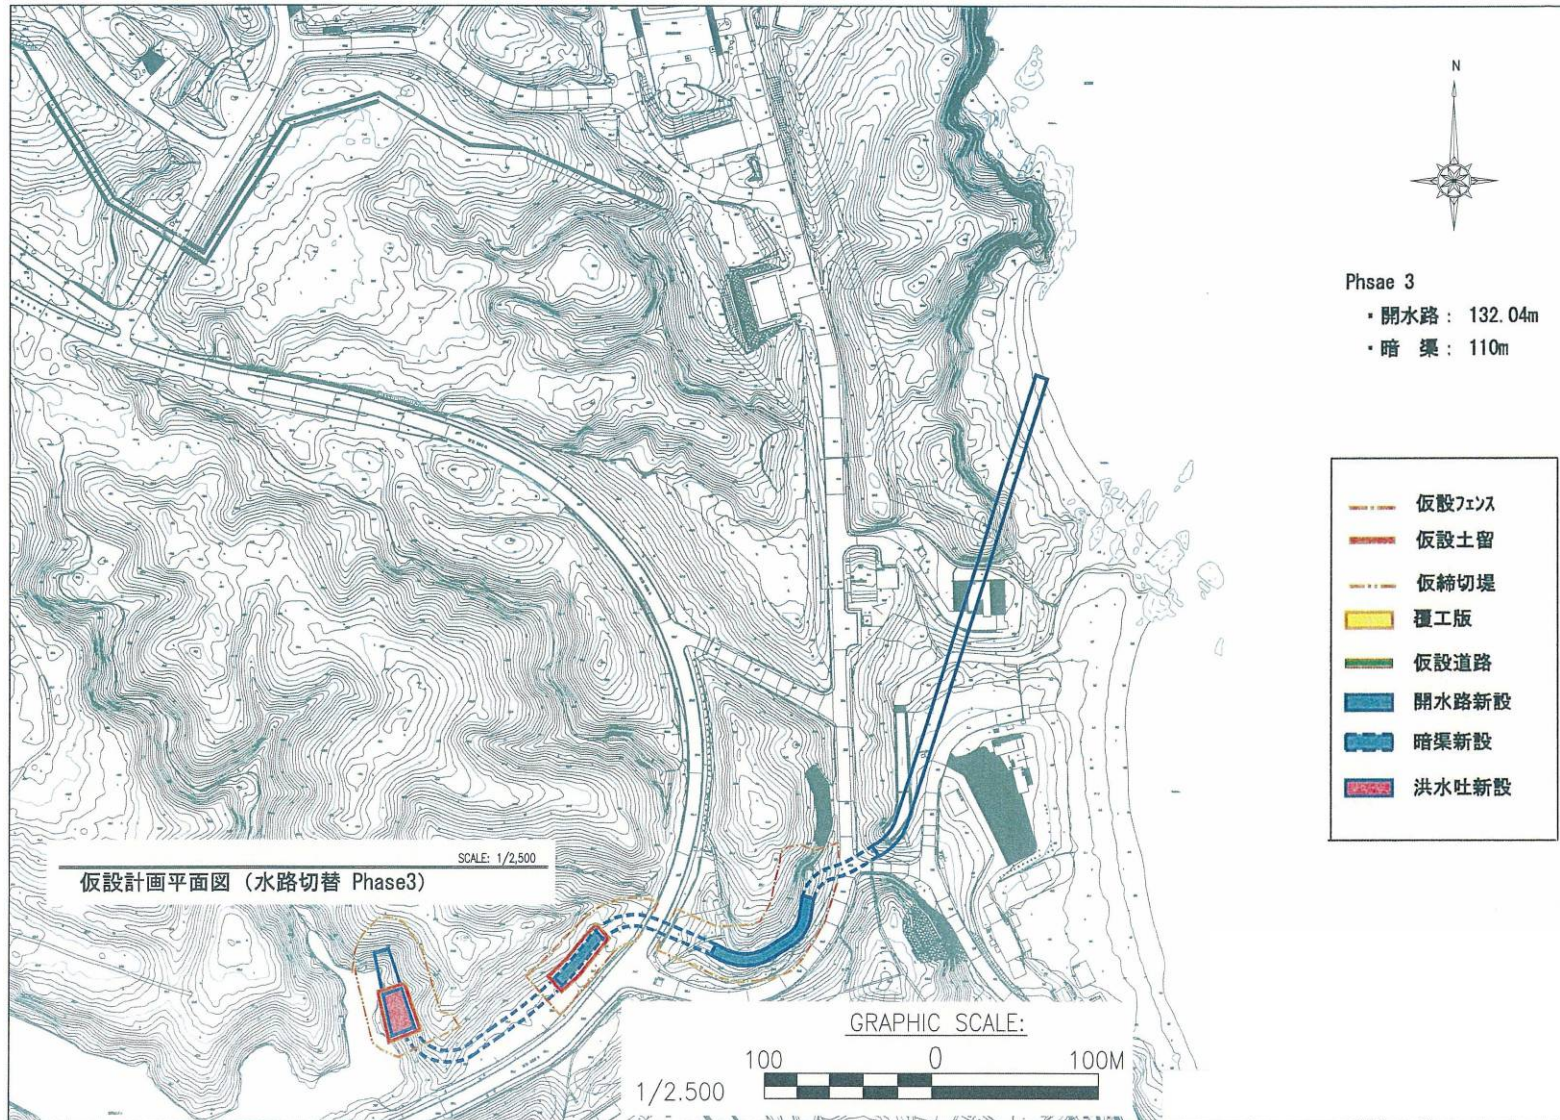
(3) 美謝川の切替え仮設計画平面図 (Phase3)
